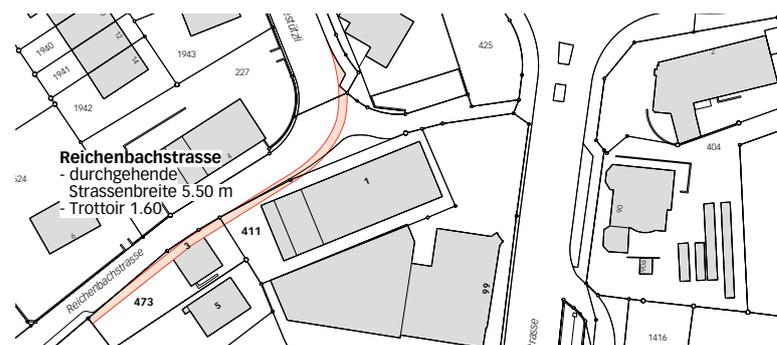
Geplante Strassenverbreiterung zur Erstellung eines durchgängigen Trottoirs
